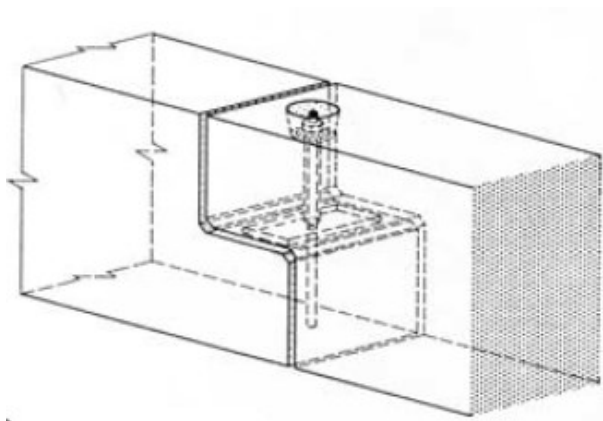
Ligação viga – viga por meio de consolas curtas (STUPRÉ, 1981).
